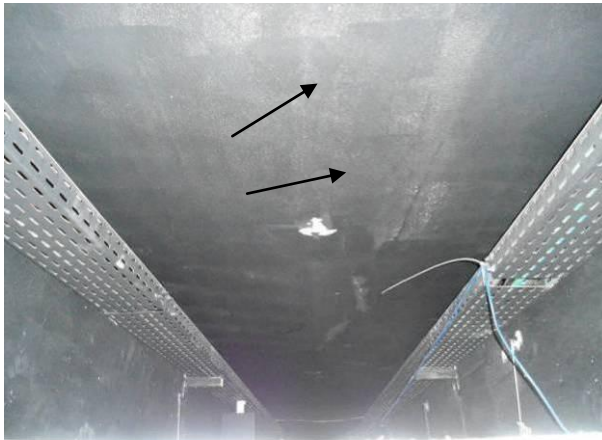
Fissura longitudinal com abertura de 0,3mm na face inferior da Laje entre os eixos 11/12 e J/K, em área com presença de forros de gesso e PVC.
